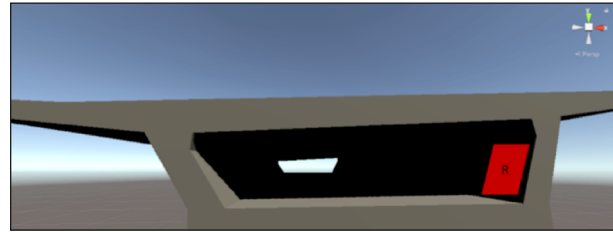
Mögliche zweidimensionale Darstellung vorhandener Schäden (Montage)
